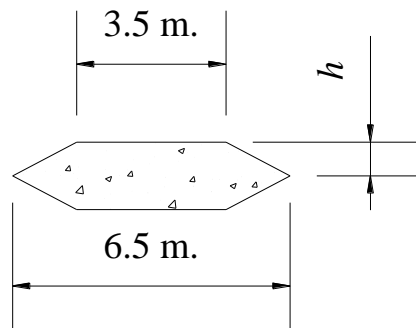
Parámetros fijados para pilas con tajamar triangular. Los valores de 6.5 m y 3.5 m se mantuvieron constantes.
